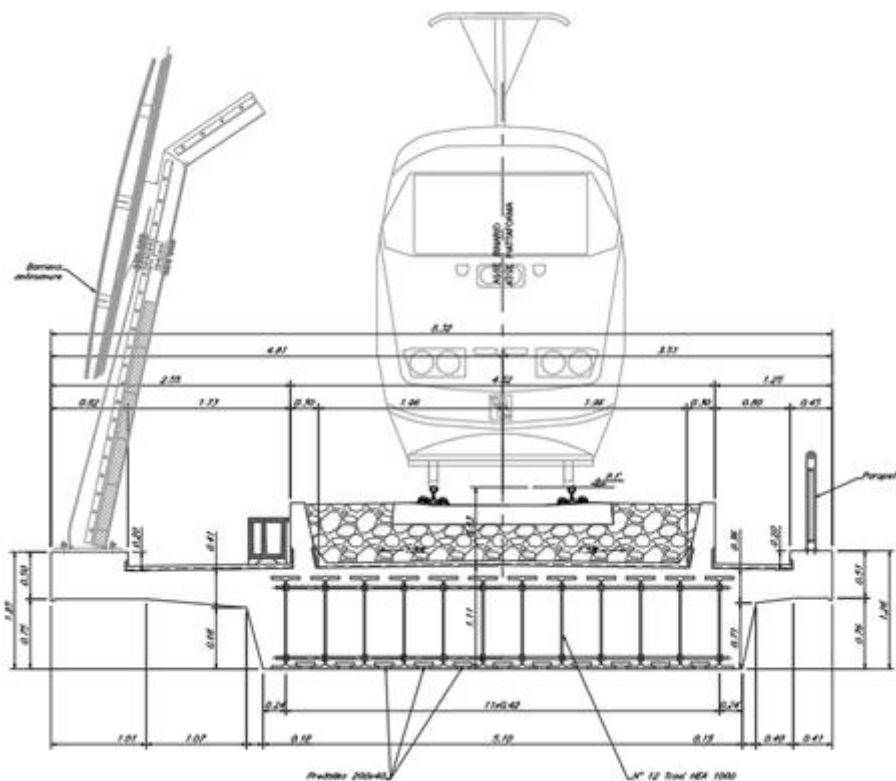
Sezione Trasversale Impalcato a travi incorporate
